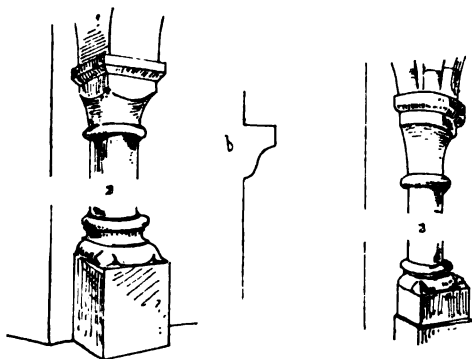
Lipp. Grundriss und Details der katholischen Pfarrkirche.
